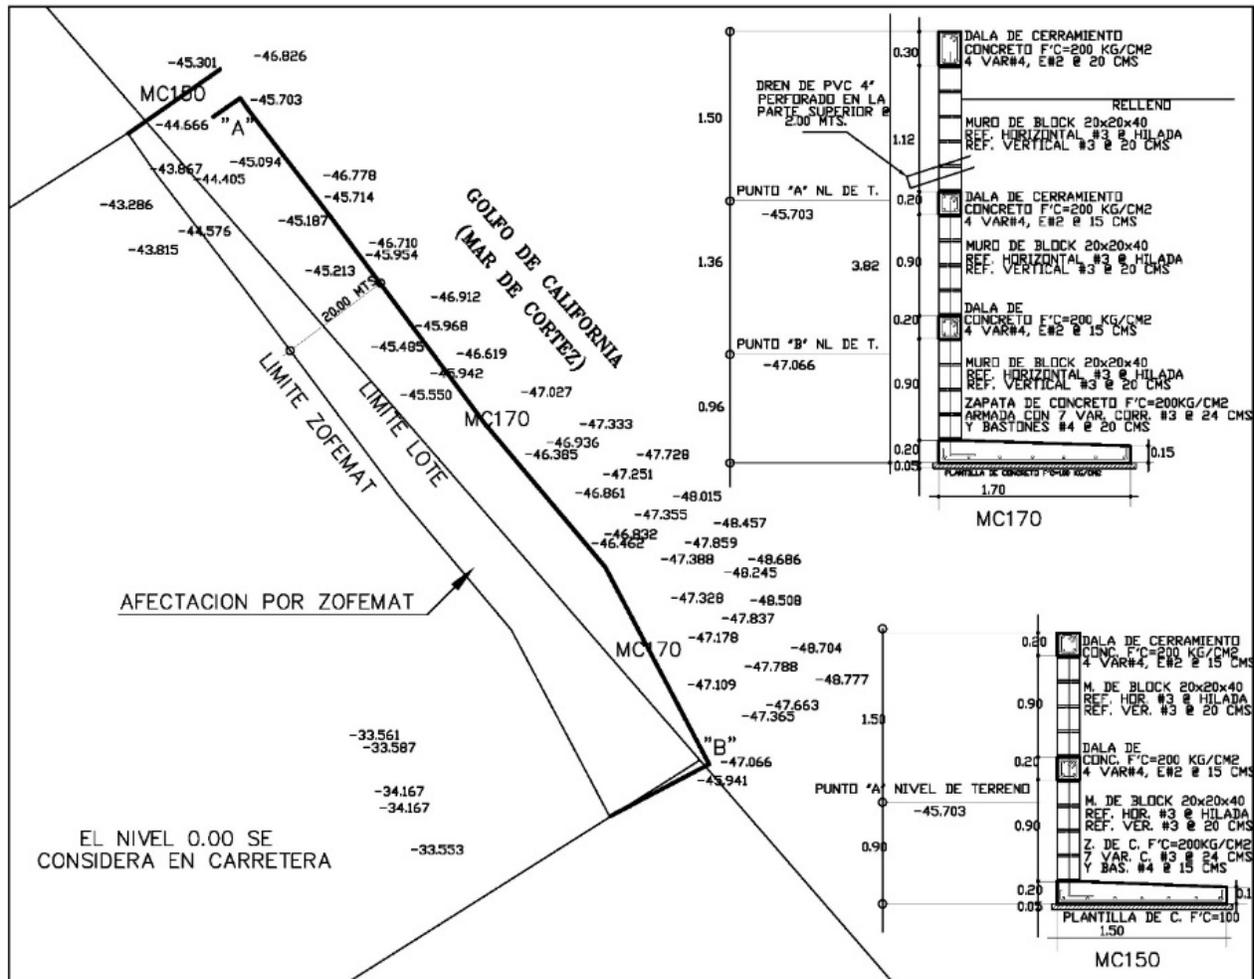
Plano Arquitectónico del Proyecto. Fuente: Plano del proyecto (Anexo IV).
